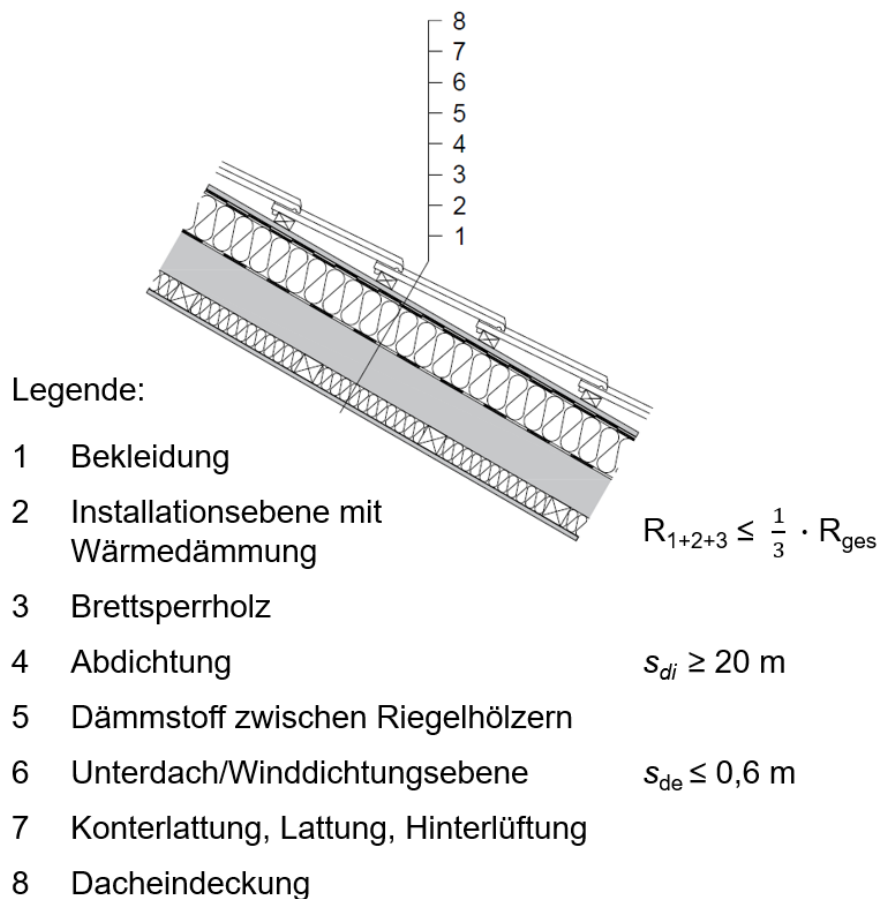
Schrägdach in Holzmassivbauweise mit Belüftung der Dacheindeckung, geändert nach [1].
